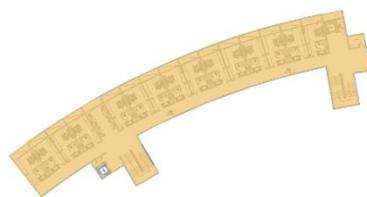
Zonificación planta general, primer nivel de la propuesta.
